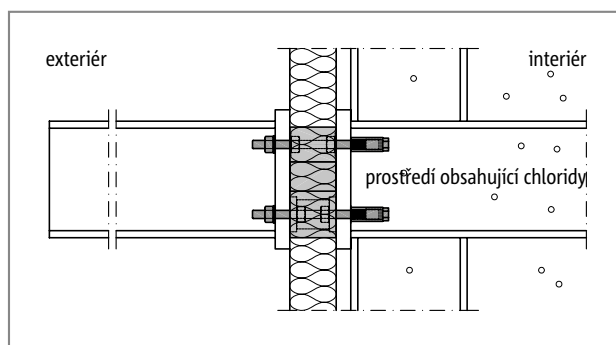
Schöck Isokorb® T typ S-N a T typ S-V: Napojení ocelové konstrukce na železobeton
